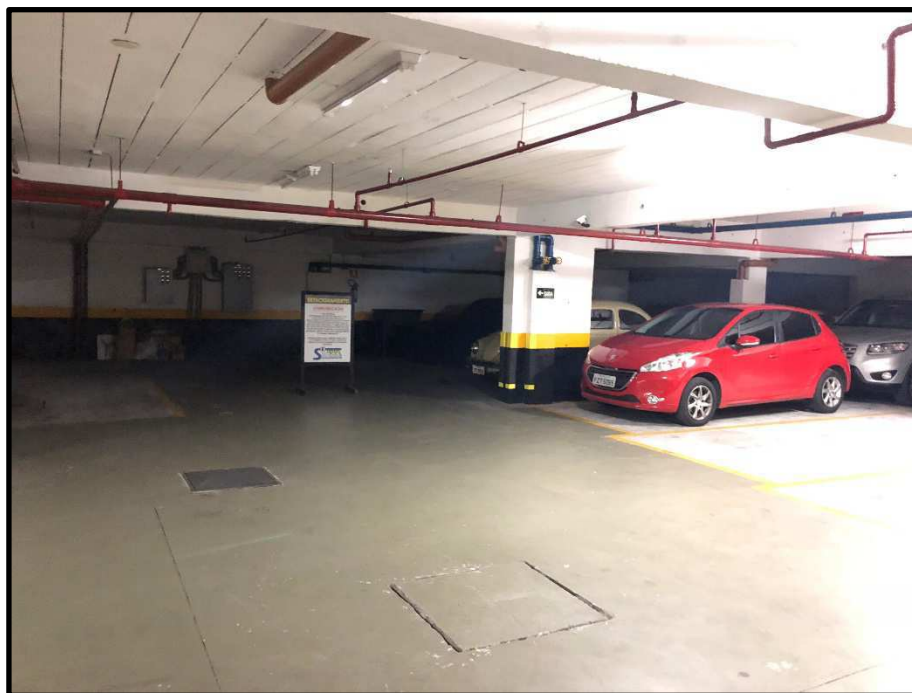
2º subsolo – vagas de garagem – Vista 3
